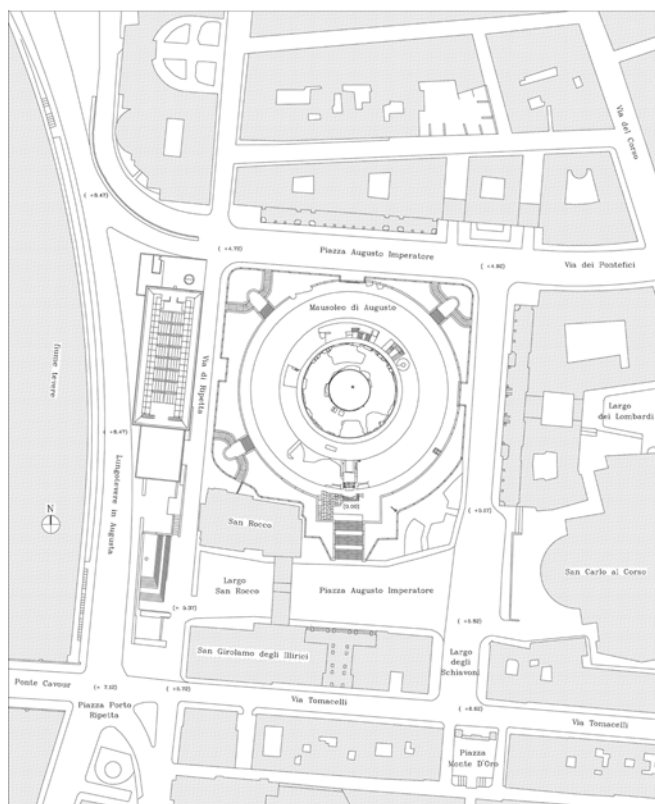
Planimetria con progetto di R.Meier, scala 1:500, 2000.
